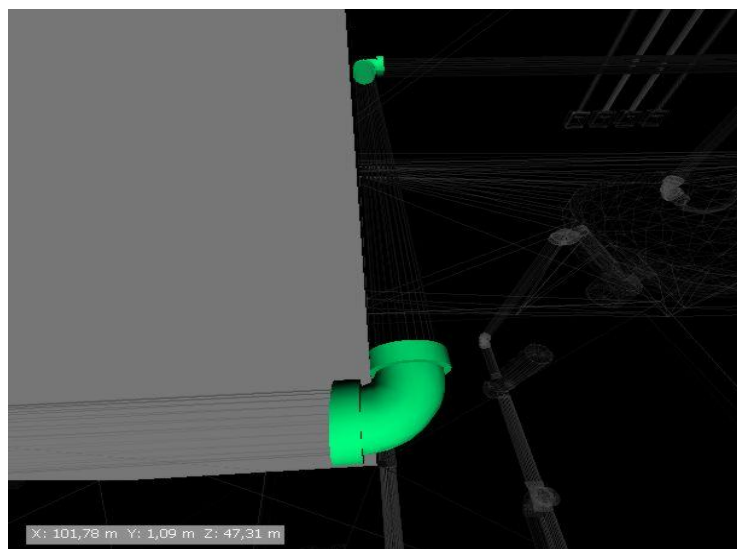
Componente de tubulação de hidráulica interceptando pilar.
